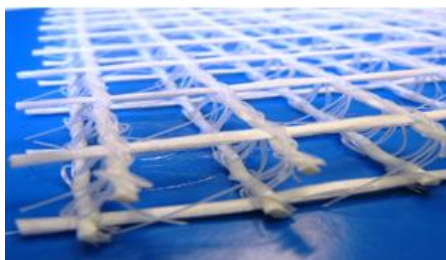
Бетон армированный полимерным каркасом и текстиль-бетон
